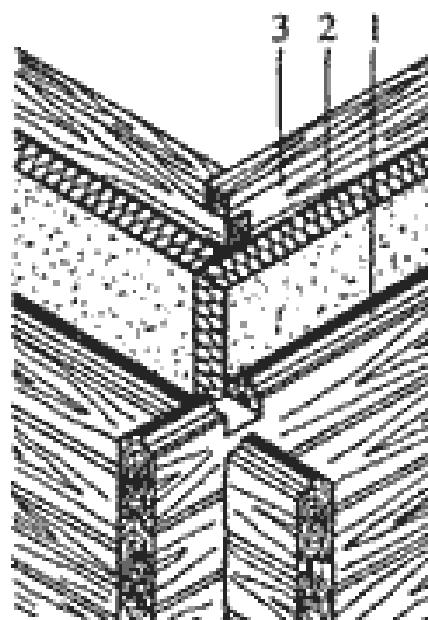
Двойная блочная стена слоистого типа с промежуточной теплоизоляцией: 1 — наружная бревенчатая стена; 2 — теплоизоляция; 3 — внутренняя обшивка.
